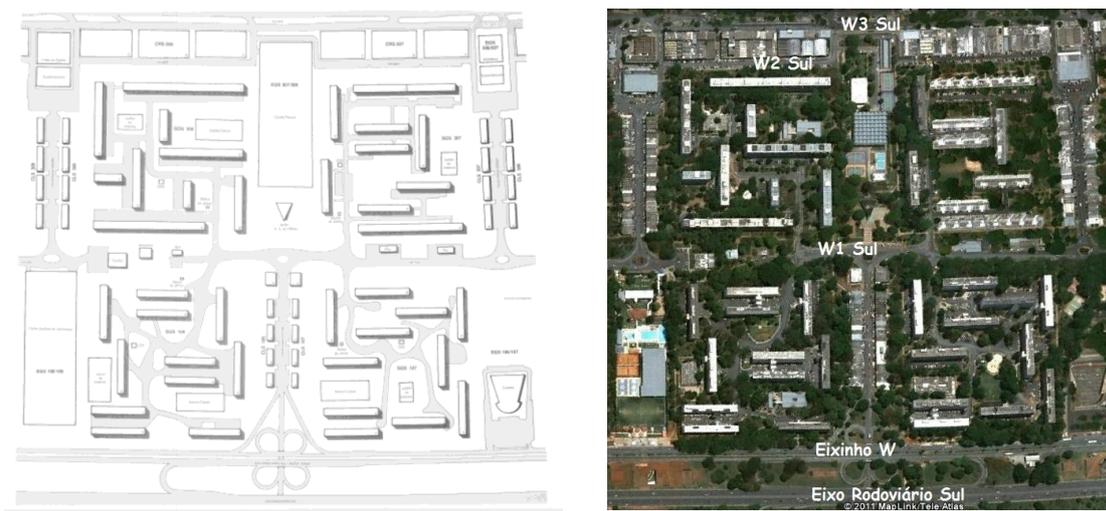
Planta da Unidade de Vizinhança 107/108/307/308.
